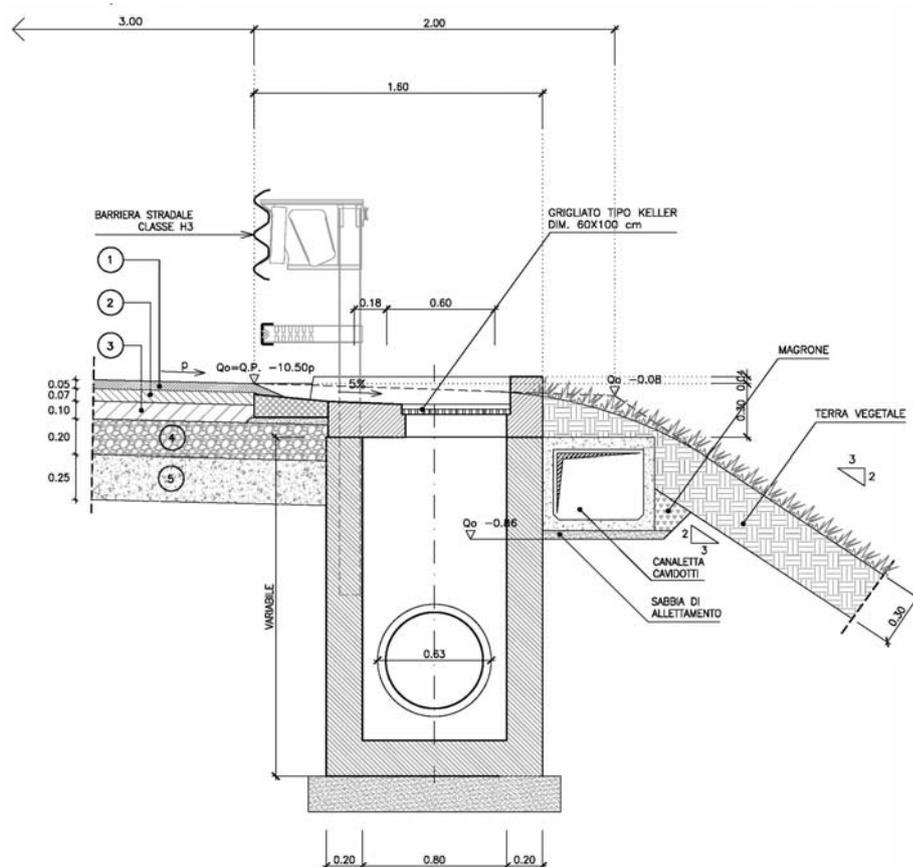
Particolare sistema di drenaggio in rilevato – Particolare pozzetto
